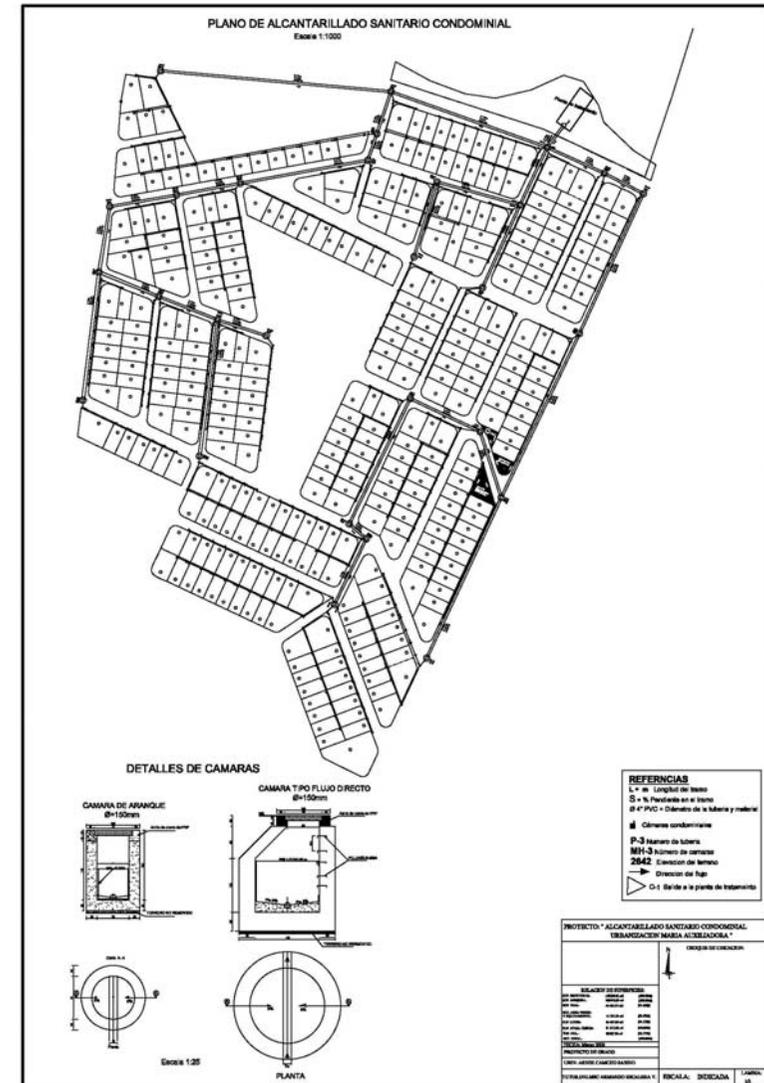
Proyecto para Alcantarillado condomineal. Sabino Arnez.
